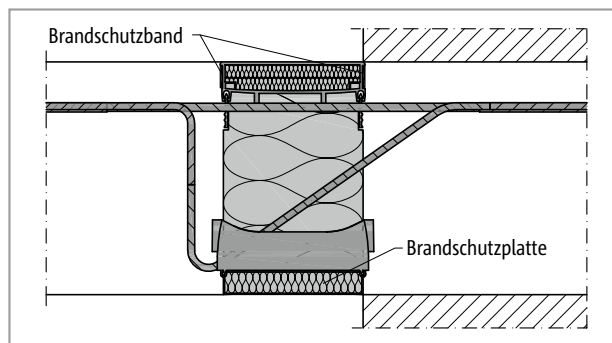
Schöck Isokorb® XT Typ K-...-REI120: Detail 1
